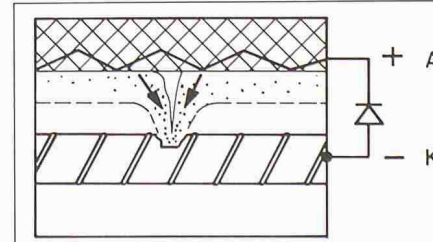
KKS bei inhomogen versalzener Betonstruktur mit ungleichmässiger Stromverteilung
